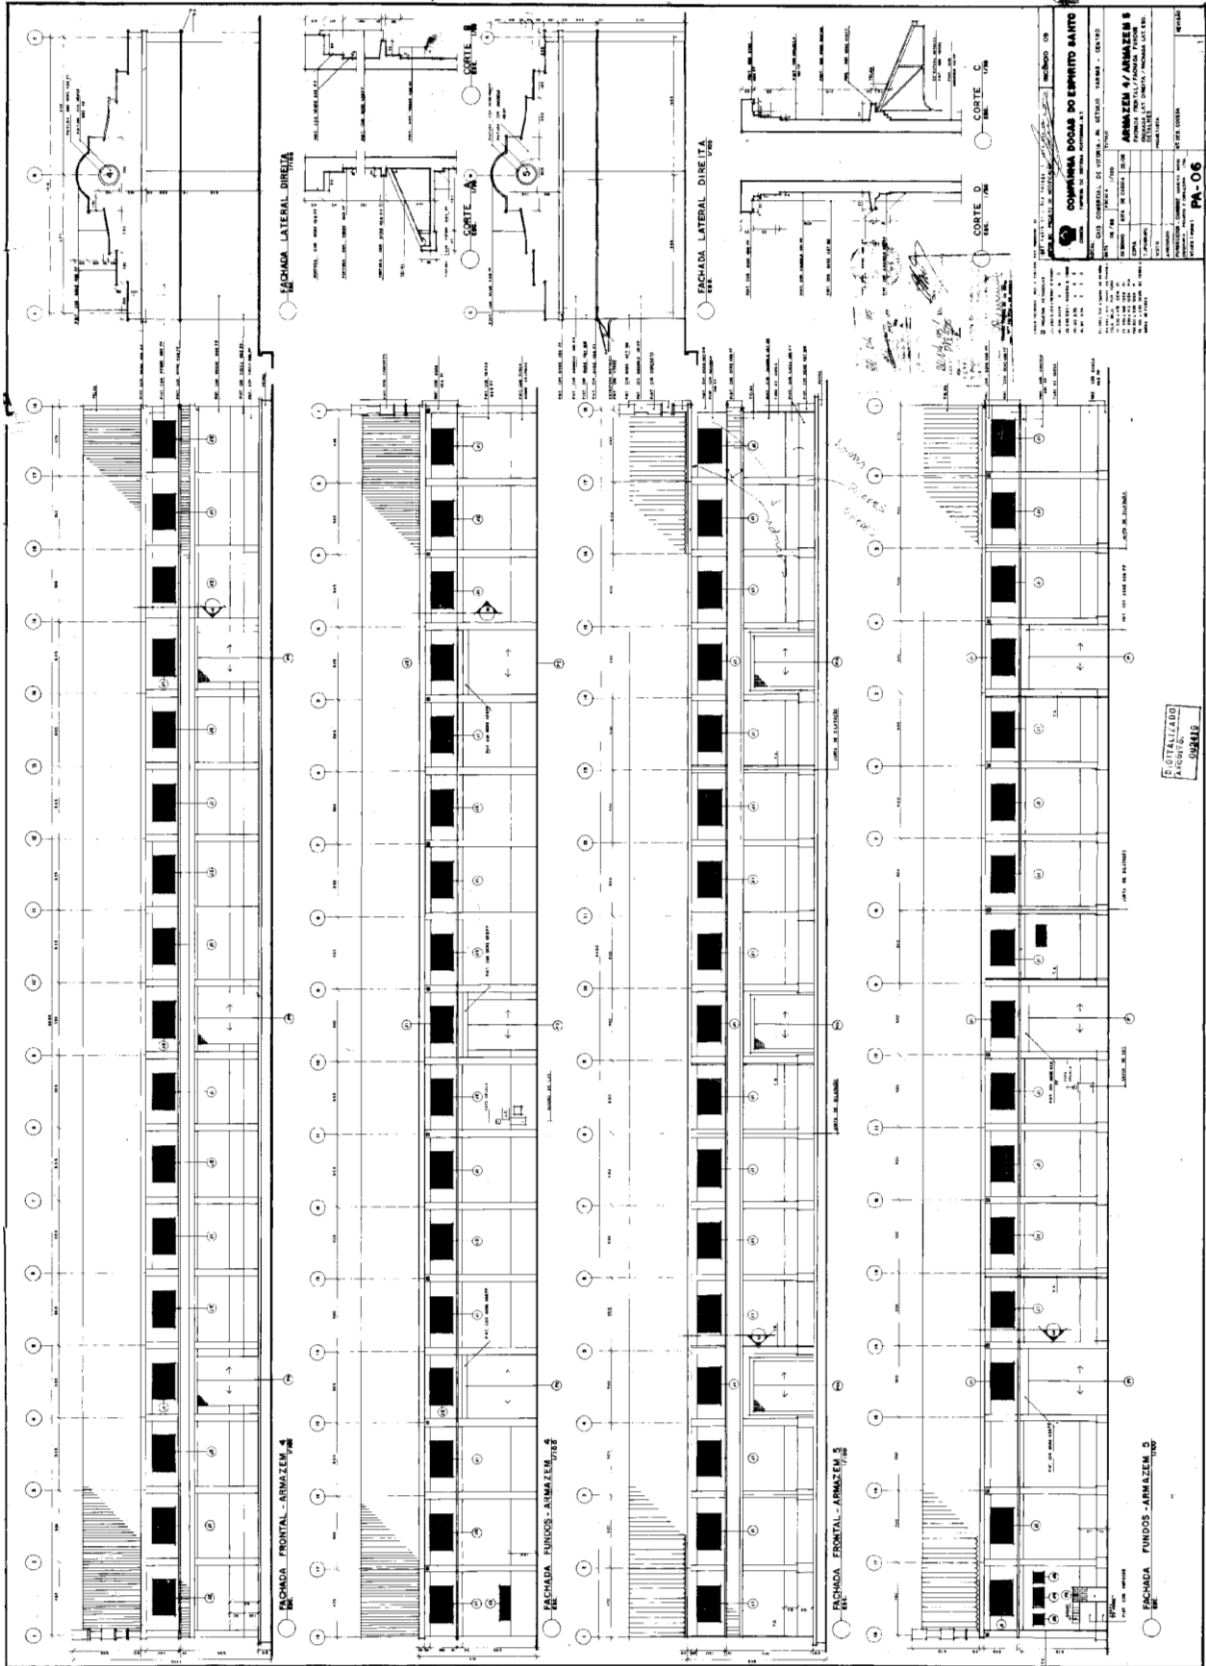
Armazéns 4 e 5: fachada frontal, fachada fundos, fachada lateral direita, fachada lateral esquerda, desenho de Rita de Cássia.
